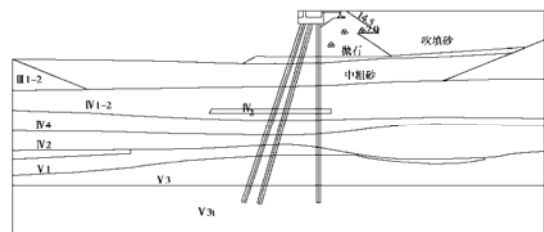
13-13 剖面双排斜顶桩板桩结构方案简化断面示意图
